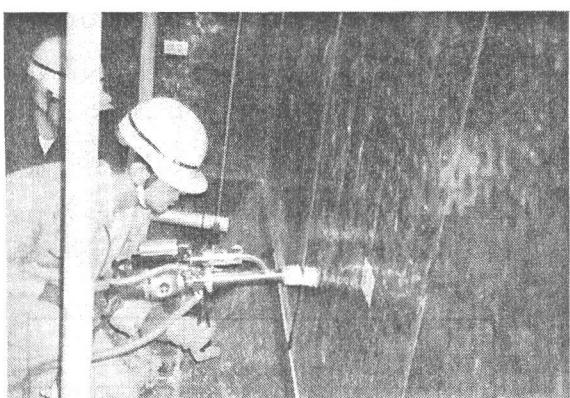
ホテル汚泥貯留槽溶接状況
